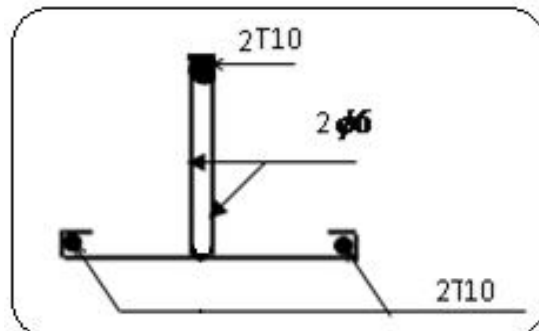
Schéma de ferrailage de la poutrelle type1.
